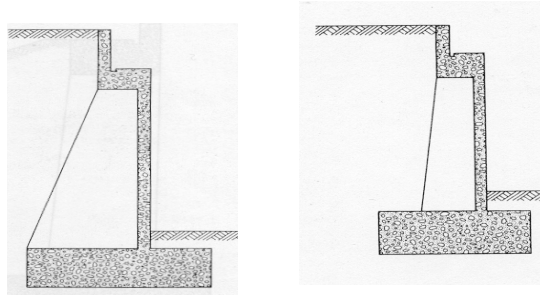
Tipos de estribos de concreto con contrafuertes
